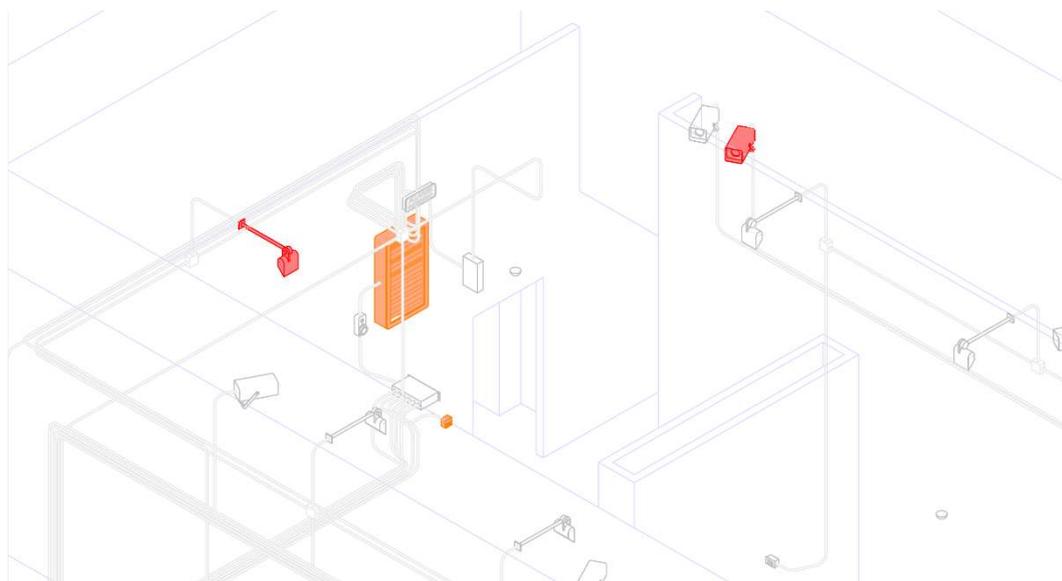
Porzione vista assonometrica ortogonale degli elementi impiantistici da revisionare o sostituire/riparare.
